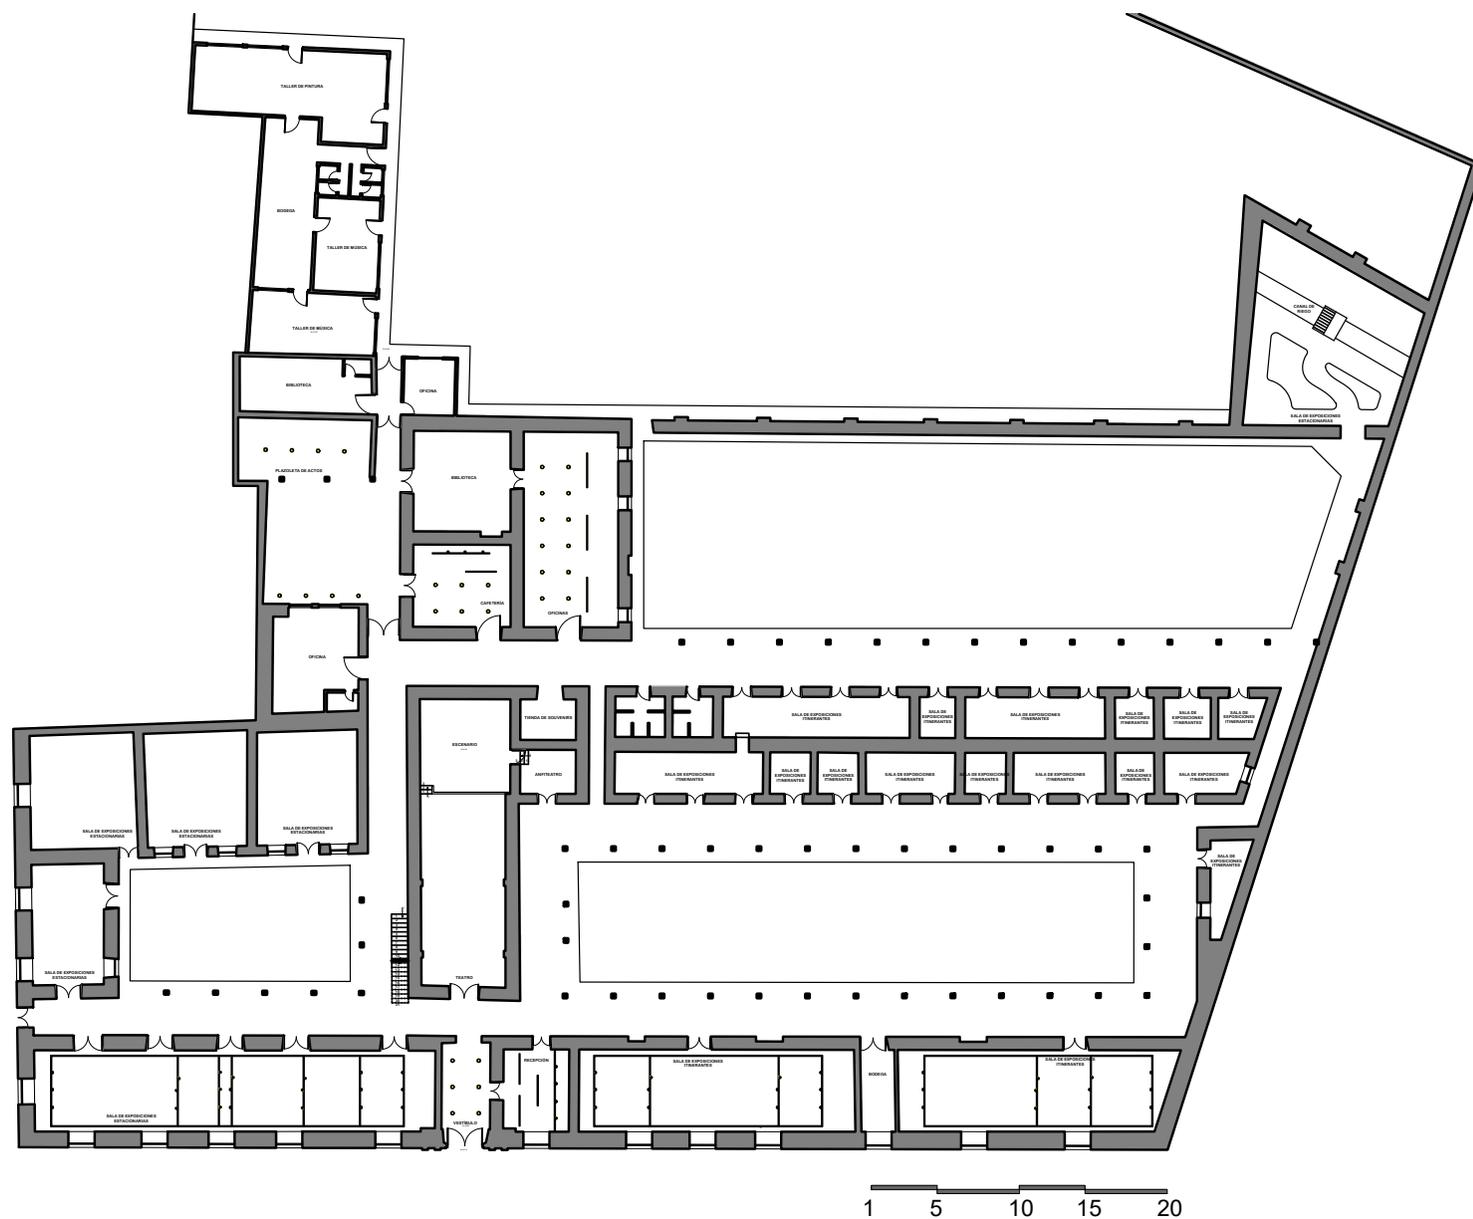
Planta de Distribución de Iluminación - Planta Baja
